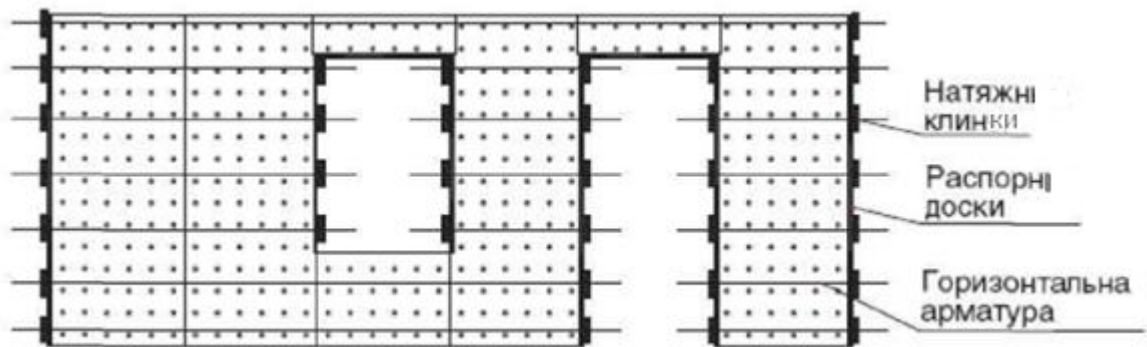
Схема розміщення арматури в елементах стінової опалубки
